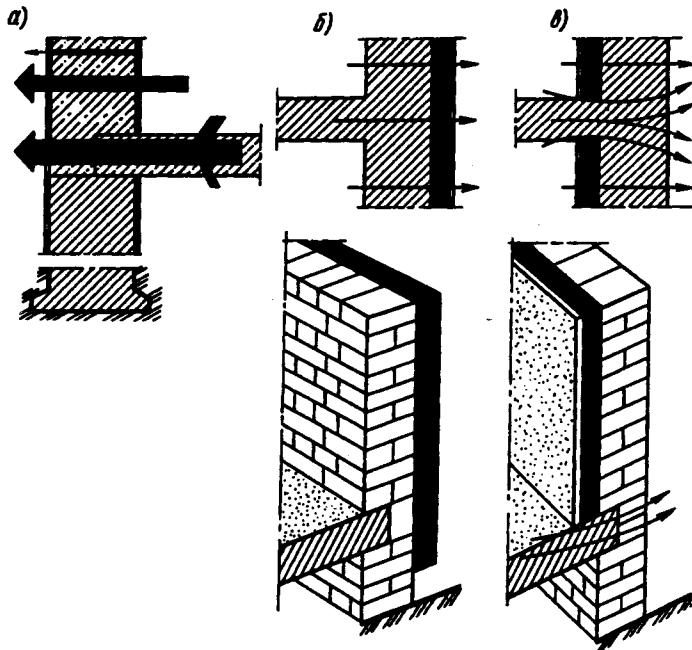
Теплопотери, происходящие через стену и через узел сопряжения балки перекрытия со стеной
